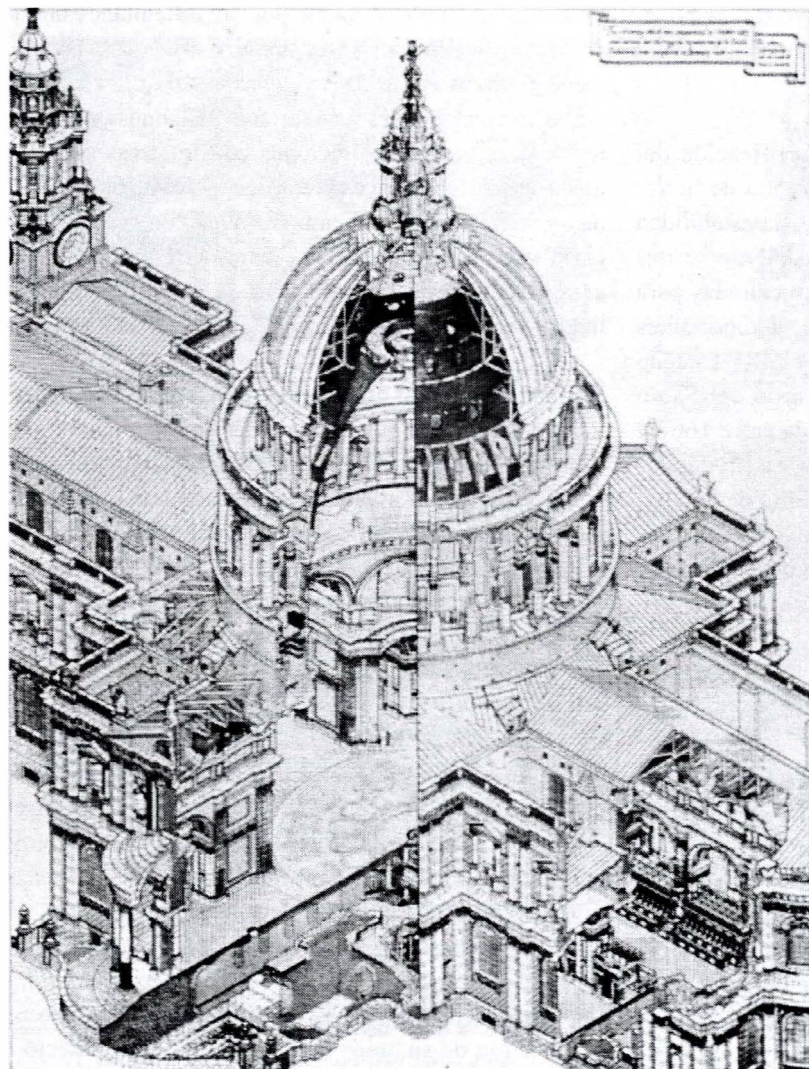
Axonometría del esquema constructivo de San Pablo. Londres
